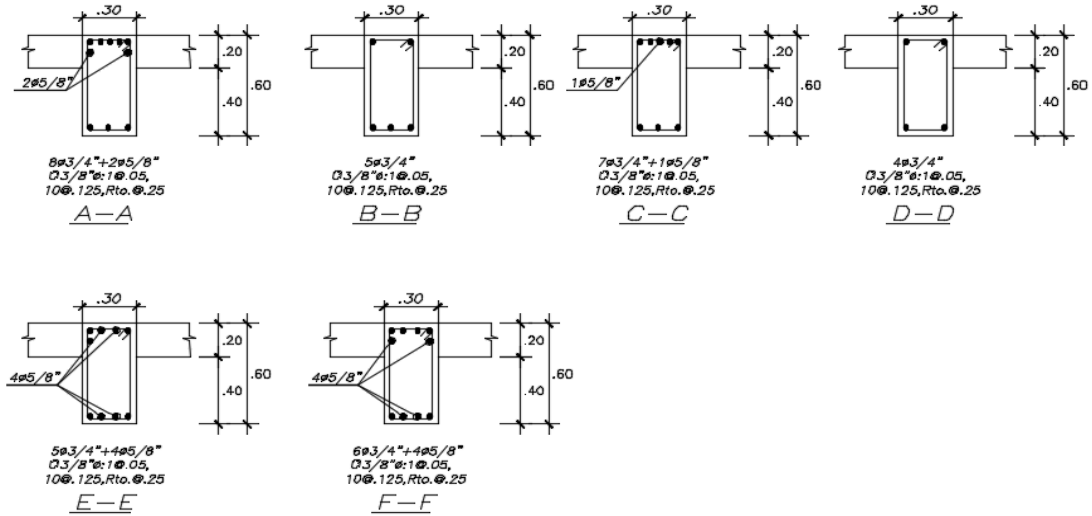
Diseño final viga V-102 (cortes de las secciones)
